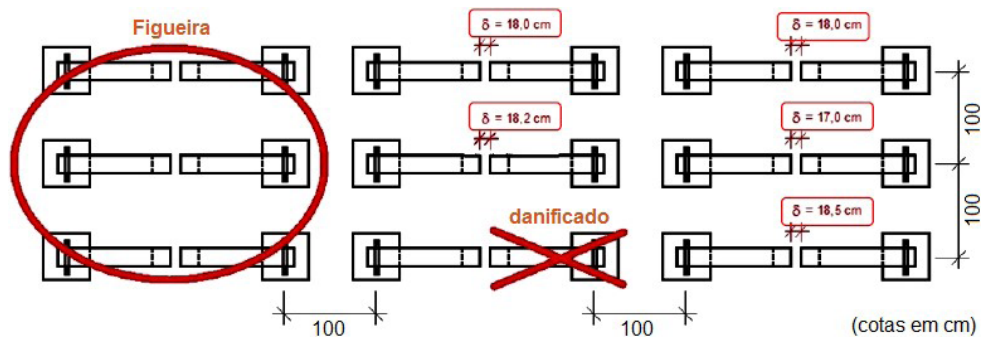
Disposição dos nove medidores de fluência do concreto da Ponte Ernesto Dornelles (AUTORES).
